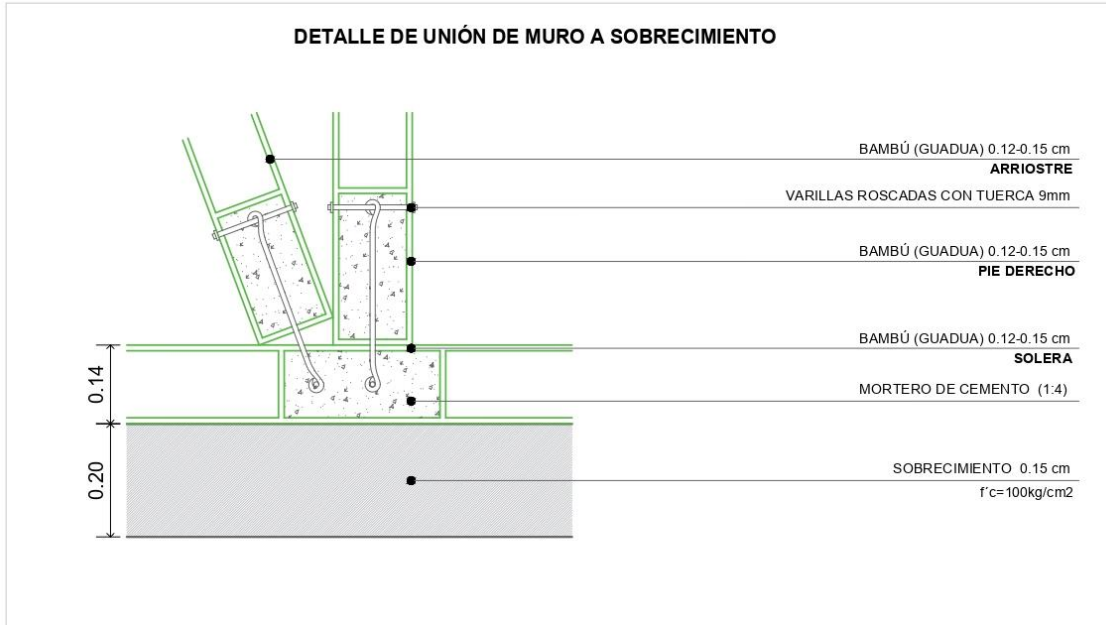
Detalle constructivo de unión entre solera, pie derecho y arriostre en muros estructurales.
